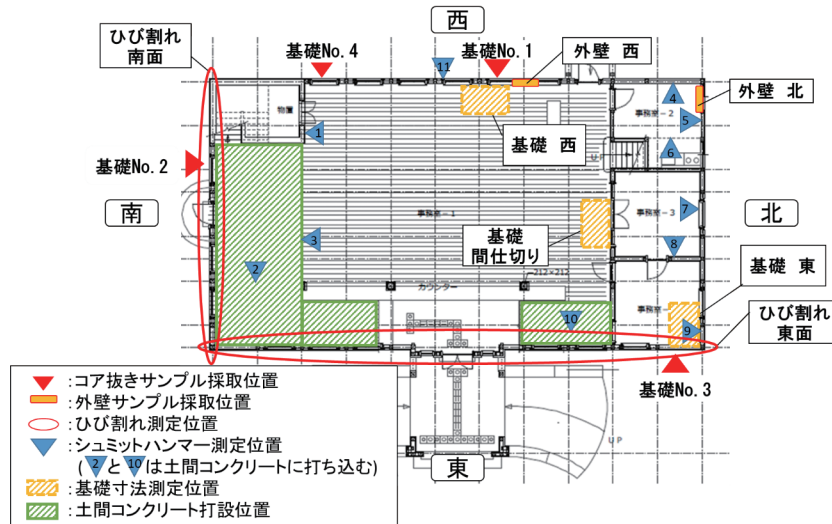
基礎寸法測定位置、ひび割れ測定位置、外壁モルタルの試料採取位置、コア供試体の採取位置および反発度の測定位置
